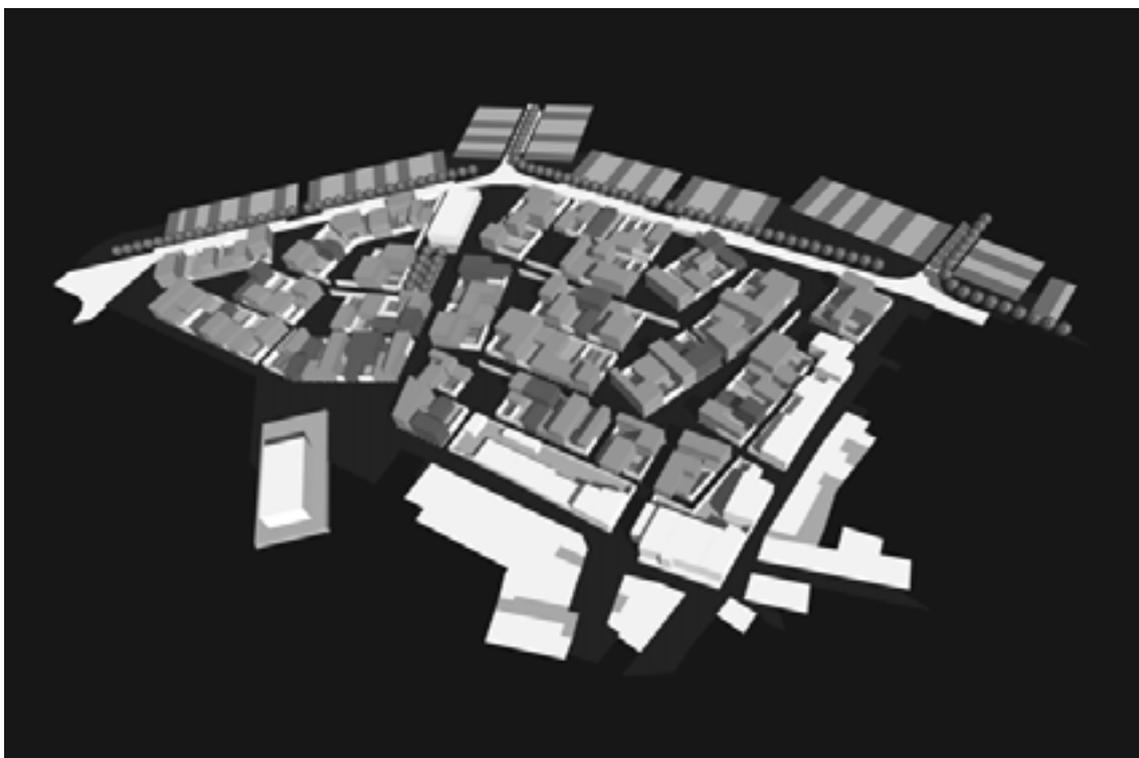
Plano do grupo 2 – Perspectiva da solução proposta.
